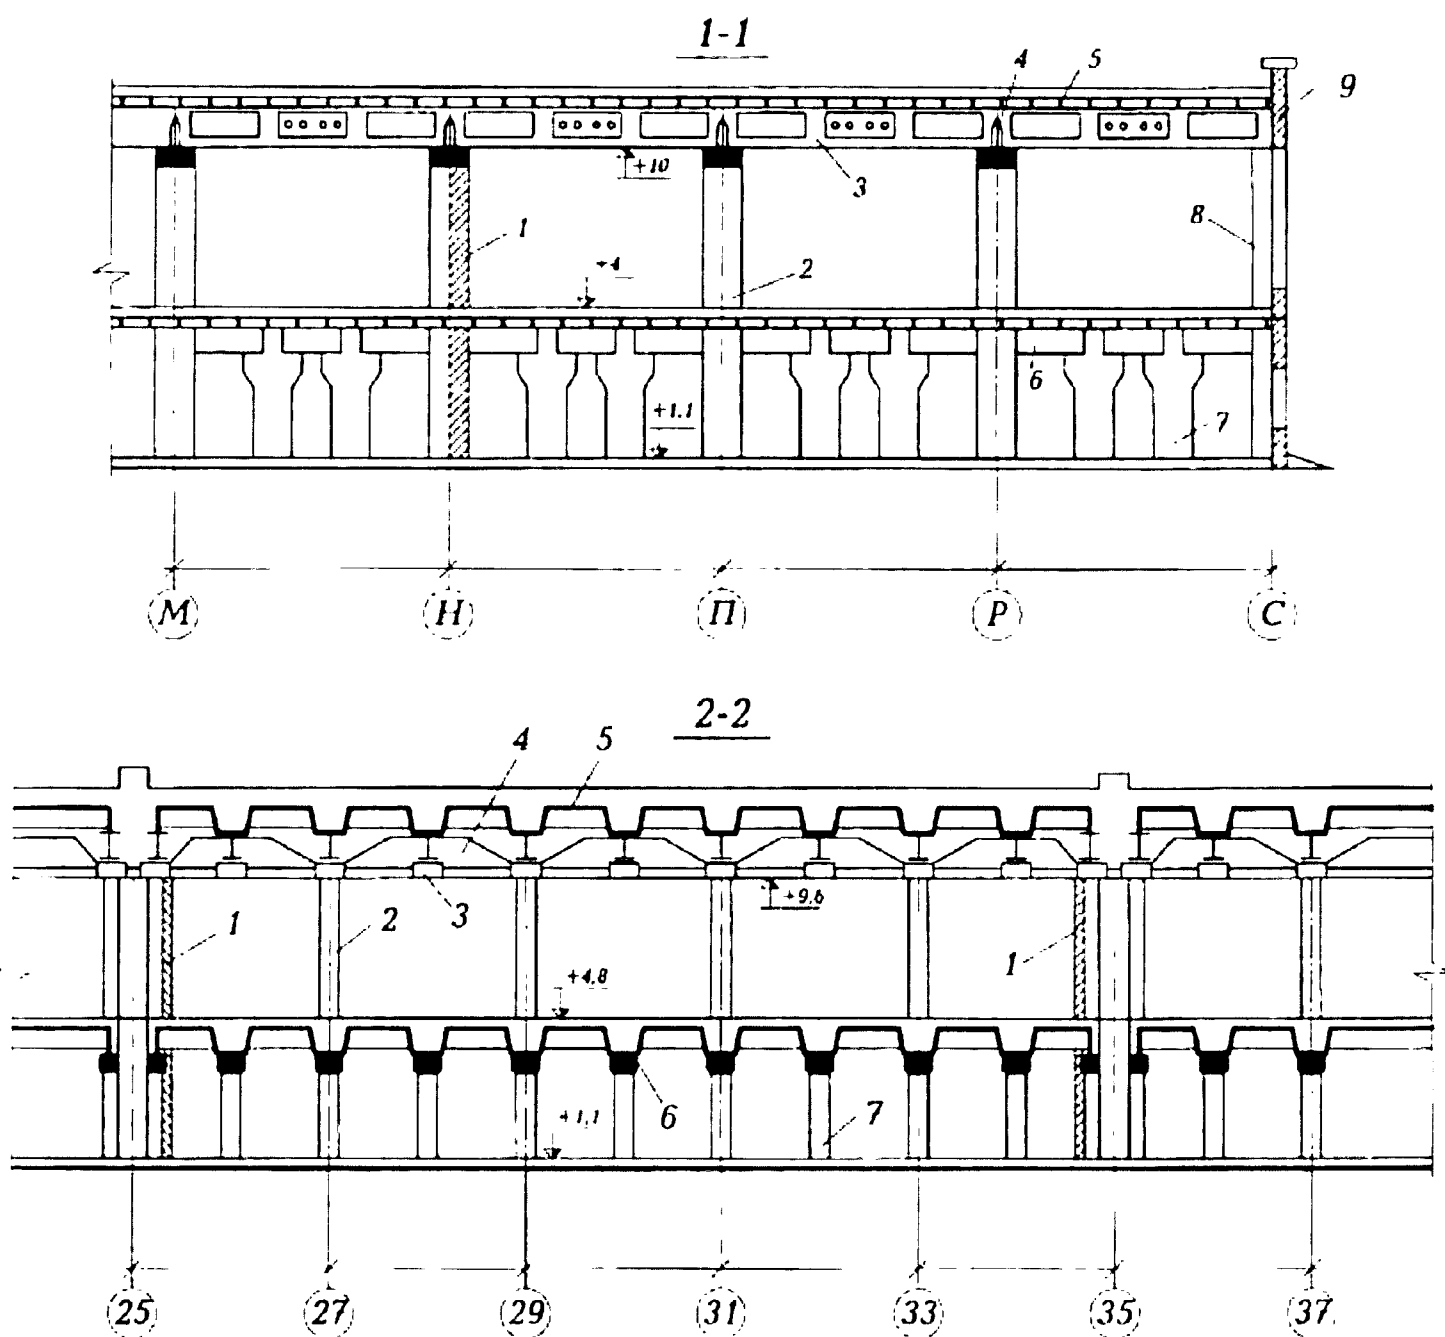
Фрагмент главного корпуса завода пластмасс. Разрезы 1-1 (в осях М-С) и 2-2 (в рядах 25-37): 1 - противопожарные стены из силикатного кирпича; 2 - колонны средние типа К-2 двухветвевые железобетонные несущего каркаса; 3 - стропильные балки железобетонные типа БПС-18; 4 - подстропильные балки железобетонные типа ББС-5П-2; 5 - плиты перекрытия типа ПНС и АКЖ; 6 - ригели этажерки; 7 - колонны первого этажа (шаг 6 м); 8 - колонны крайние типа К-1 (шаг 6 м); 9 - навесные керамзитобетонные панели
